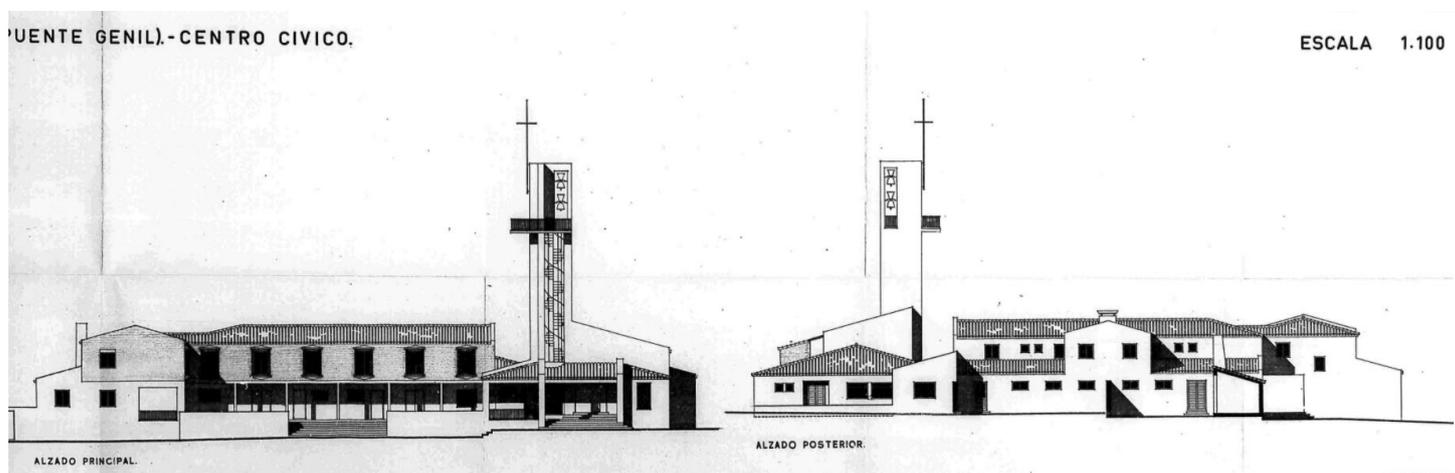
Alzado principal y alzado posterior del centro cívico.
